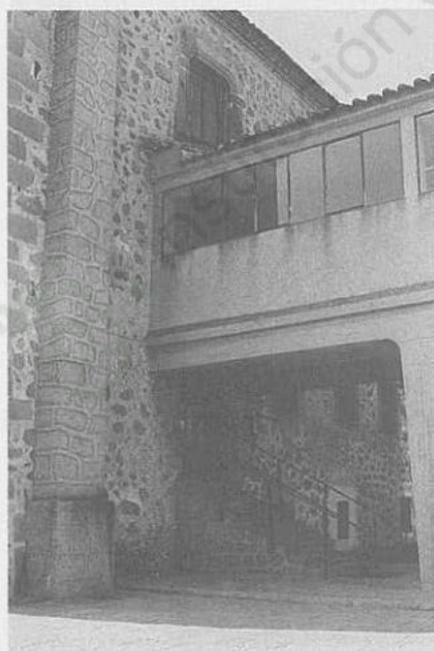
Claustro de los Reyes. Panda este. Fachada este. Tercio meridional. Conexión del antiguo complejo conventual con la residencia de estudiantes.
